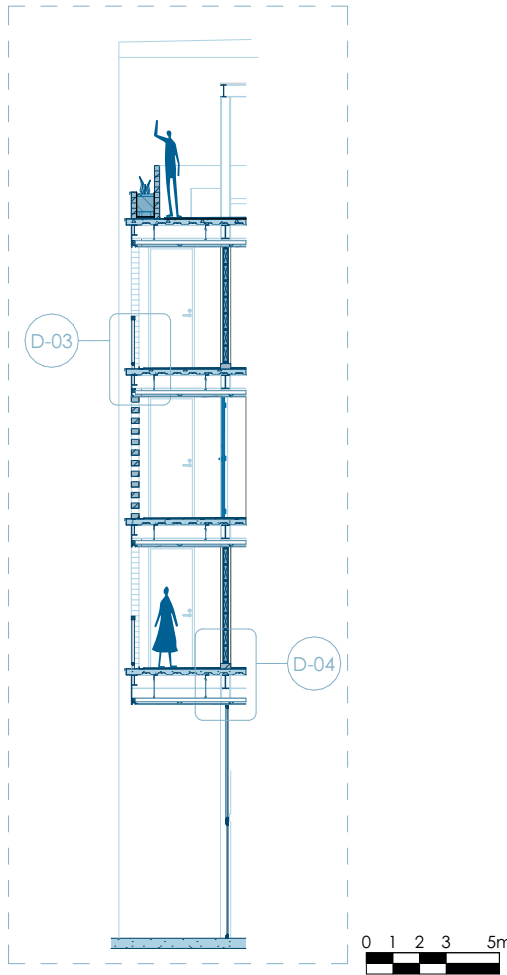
Sección constructiva B. Nota. Elaboración propia.
